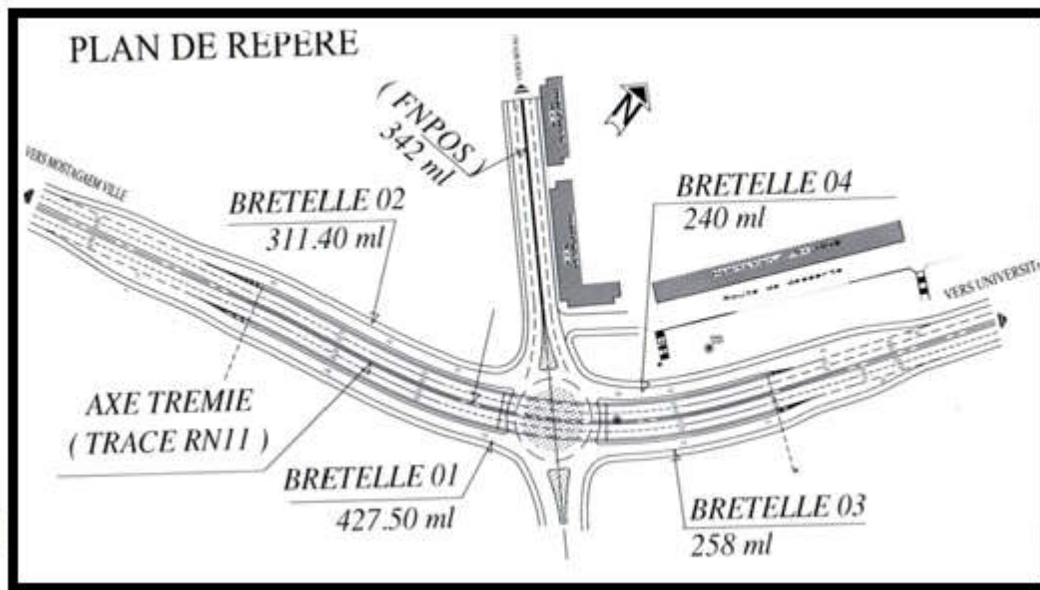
plan d'ensemble [Covadis-Autocad 2008]
